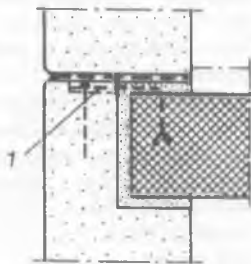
Деталь крепления несущей стены к монолитному перекрытию
